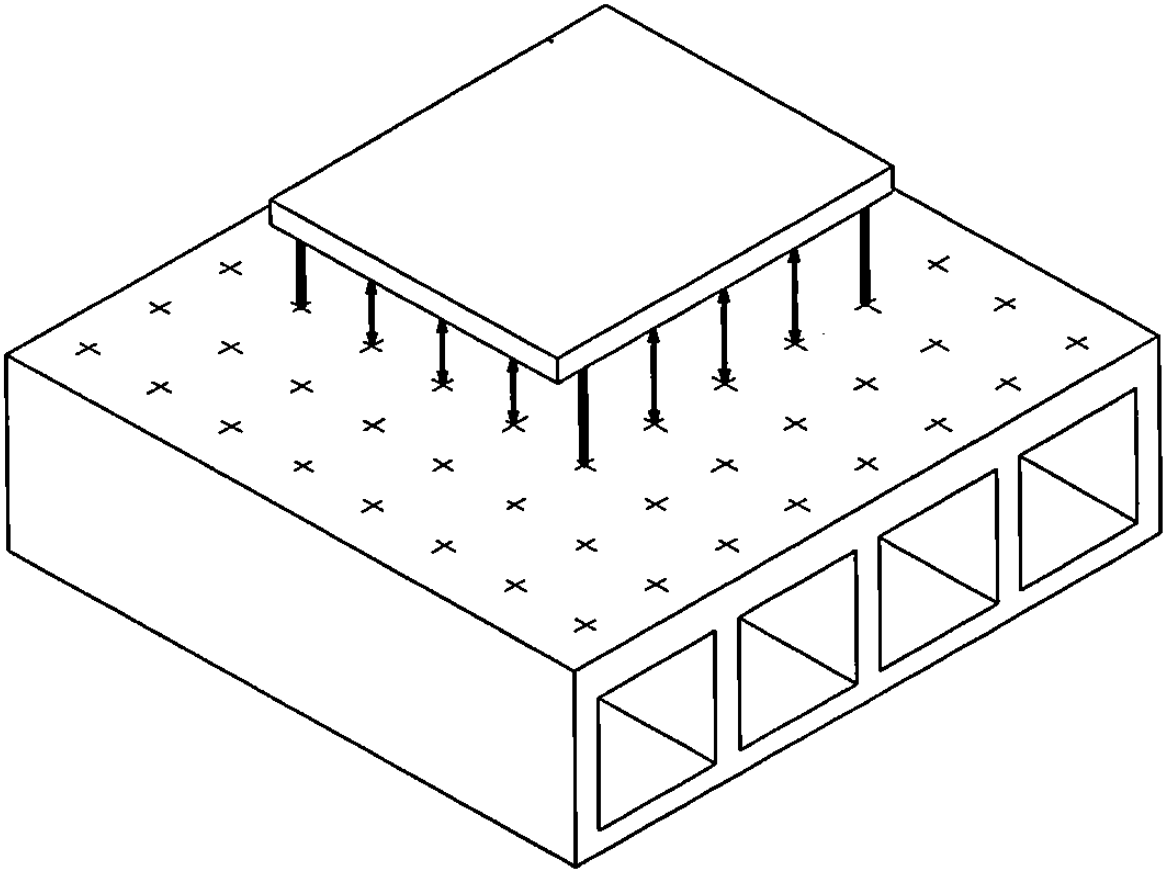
ENSAYE No. 3 LOSA APOYADA EN DOS DIRECCIONES
